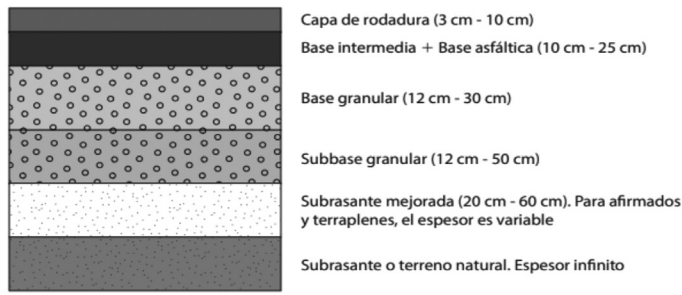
Perfil típico de una estructura de pavimento flexible (Rondón y Reyes, 2015)
